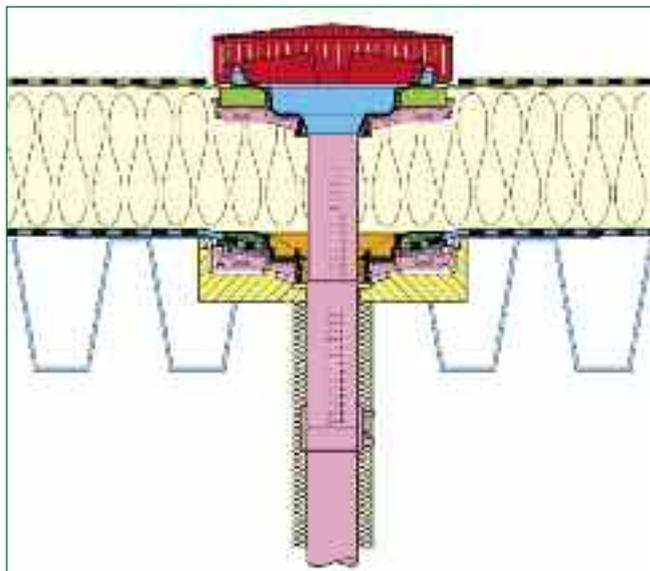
Pluvia kann bei allen gängigen Dachaufbauten – rund 20 verschiedenen Dachfolien, Bitumendachbahnen und begrünten Dächern – verwendet werden
